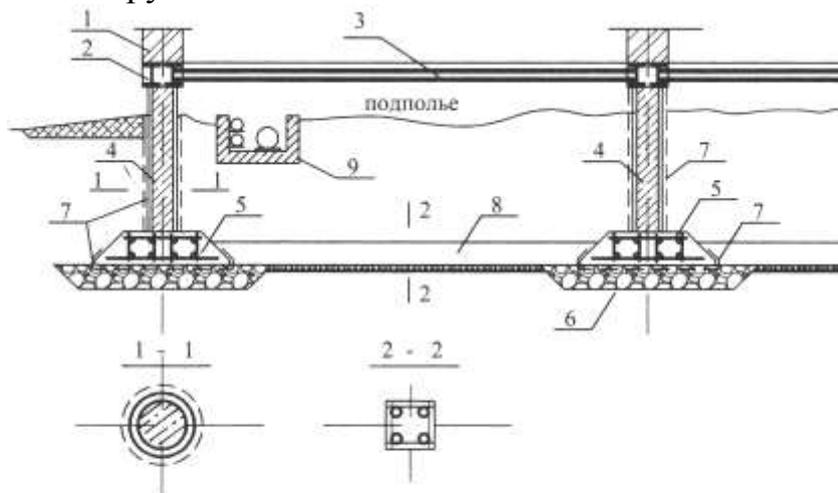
Вариант эскизного решения сейсмостойкого фундамента здания с кирпичными стенами (1 – наружные стены, 2 – верхний пояс, 3 – перекрытие (утепление условно не показано), 4 – стойки квадратного сечения с кожухом или труботетонные, 5 – фундаментные ленты, 6 – сейсмоизолирующая подушка, 7 – полимерная пленка, 8 – распорки, 9 – подпольные каналы). Примечание: Для зданий из деревянных конструкций (стен и перекрытий) – решения аналогичны.
